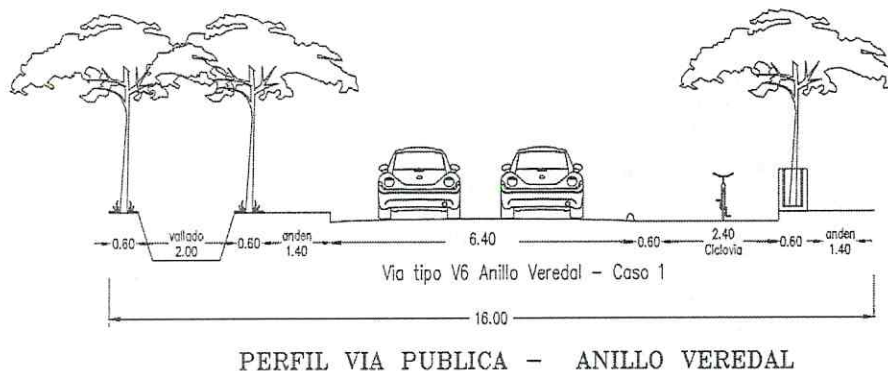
Perfil vial propuesto SERVIDUMBRE PUBLICA
